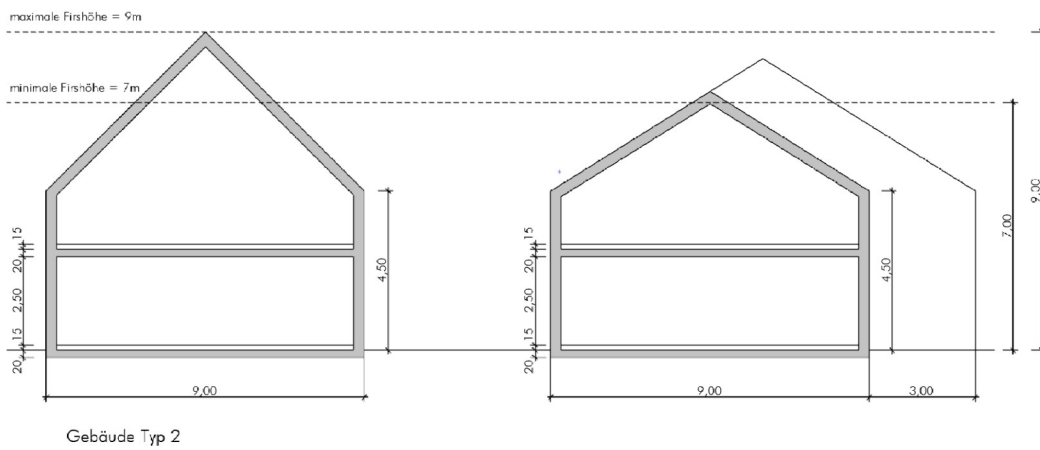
Gebäudetyp 2, links mit 45° DN, rechts mit 33° DN
